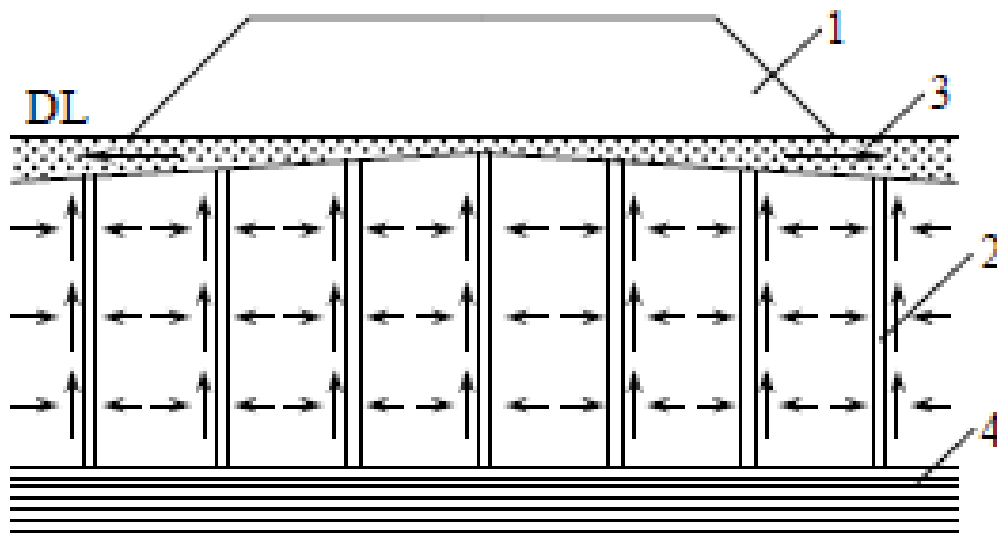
Схема уцілювання водонасиченого ґрунту за допомогою штучних дрен та з використанням додаткового навантаження: 1 – додаткове навантаження насипом; 2 – вертикальна дрена; 3 – піщаний дренаж; 4 – щільний підстильний ґрунт
